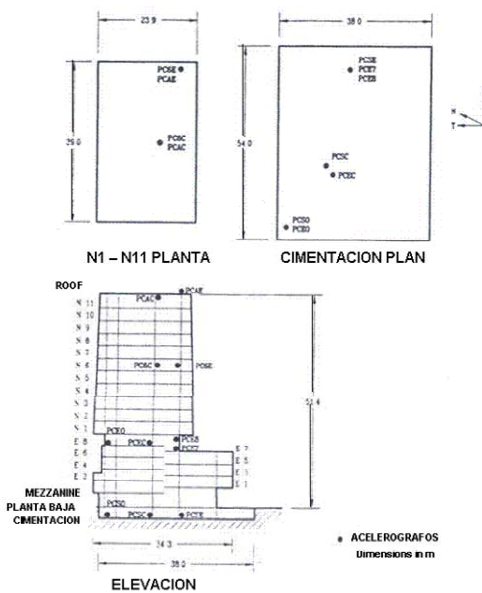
Vista esquemática (planta y elevación) del edificio instrumentado PC
